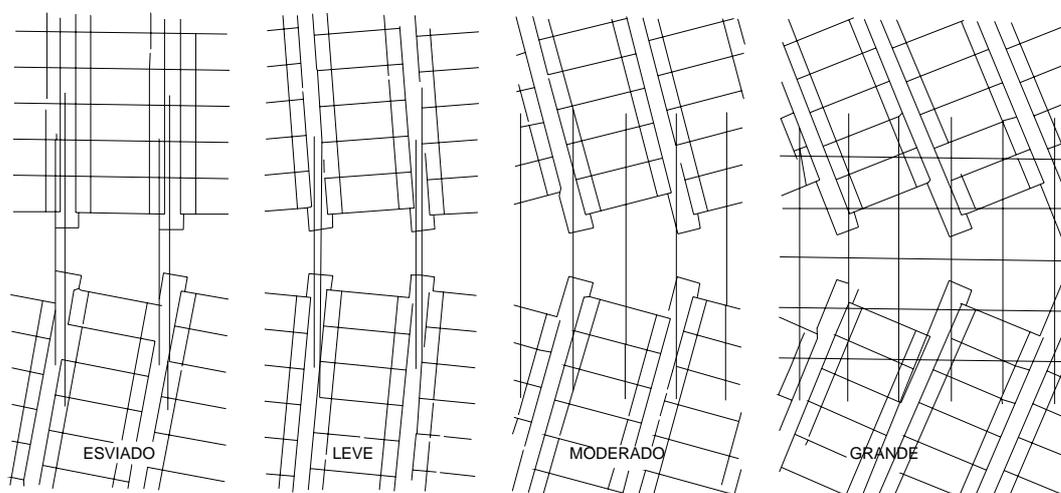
c Encuentro oblicuo de viguetas
